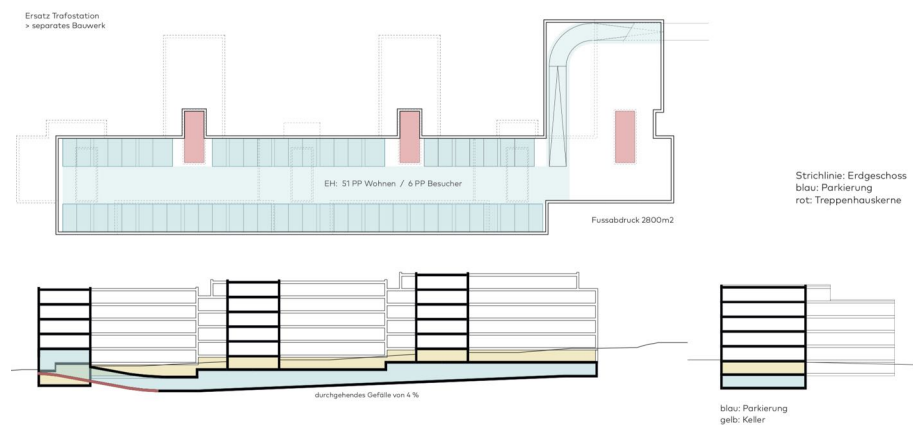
2. Untergeschoss mit der unterirdischen Einstellhalle
